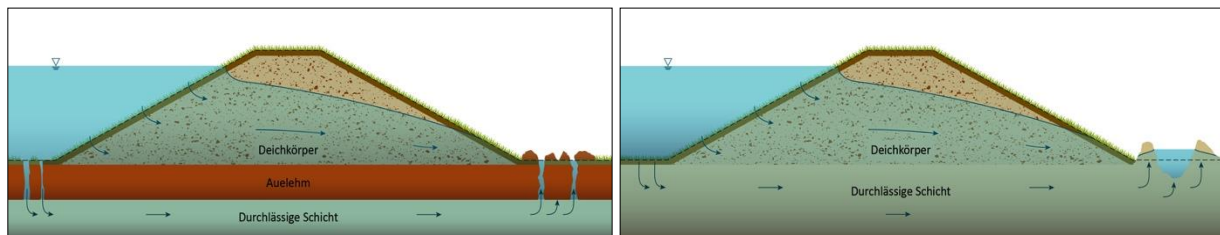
Hydraulischer Grundbruch mit geringdurchlässigem Untergrund (Auelehm) (links); Hydraulischer Grundbruch ohne geringdurchlässigen Untergrund (rechts)
